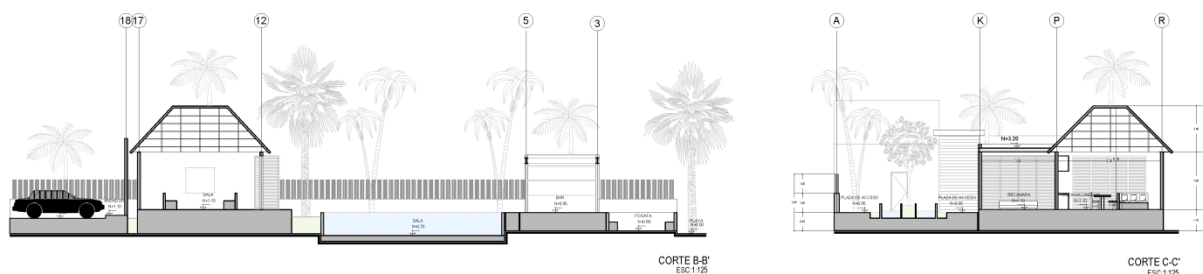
Cortes de las fachadas que compondrán la casa habitación.
